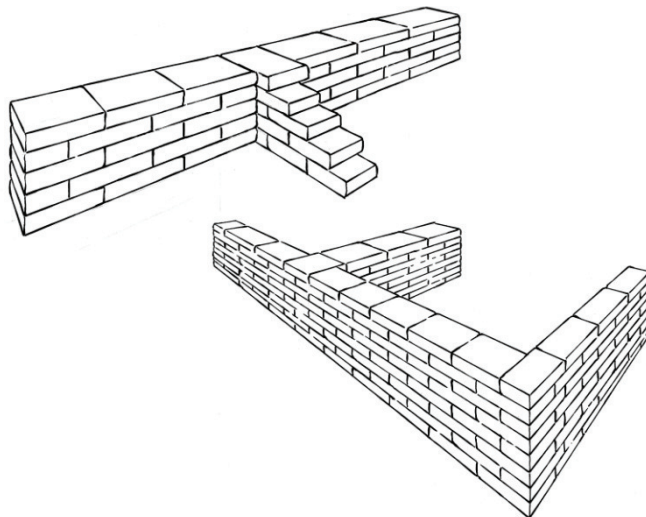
Paredes externas e suas conexões com as paredes internas
